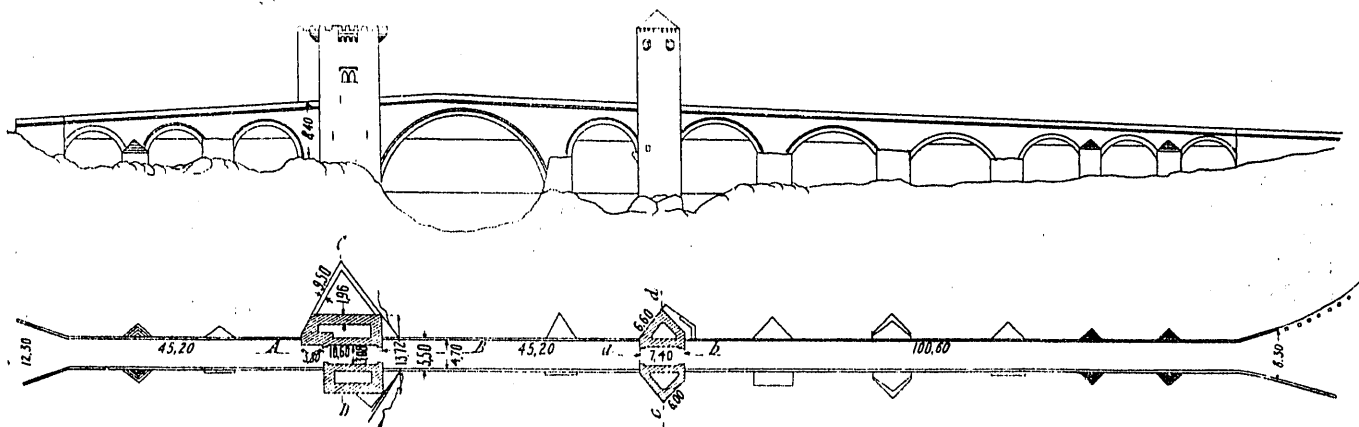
ª—Alzado y planta del puente del Arzobispo, antes de la demolición de sus torres.
